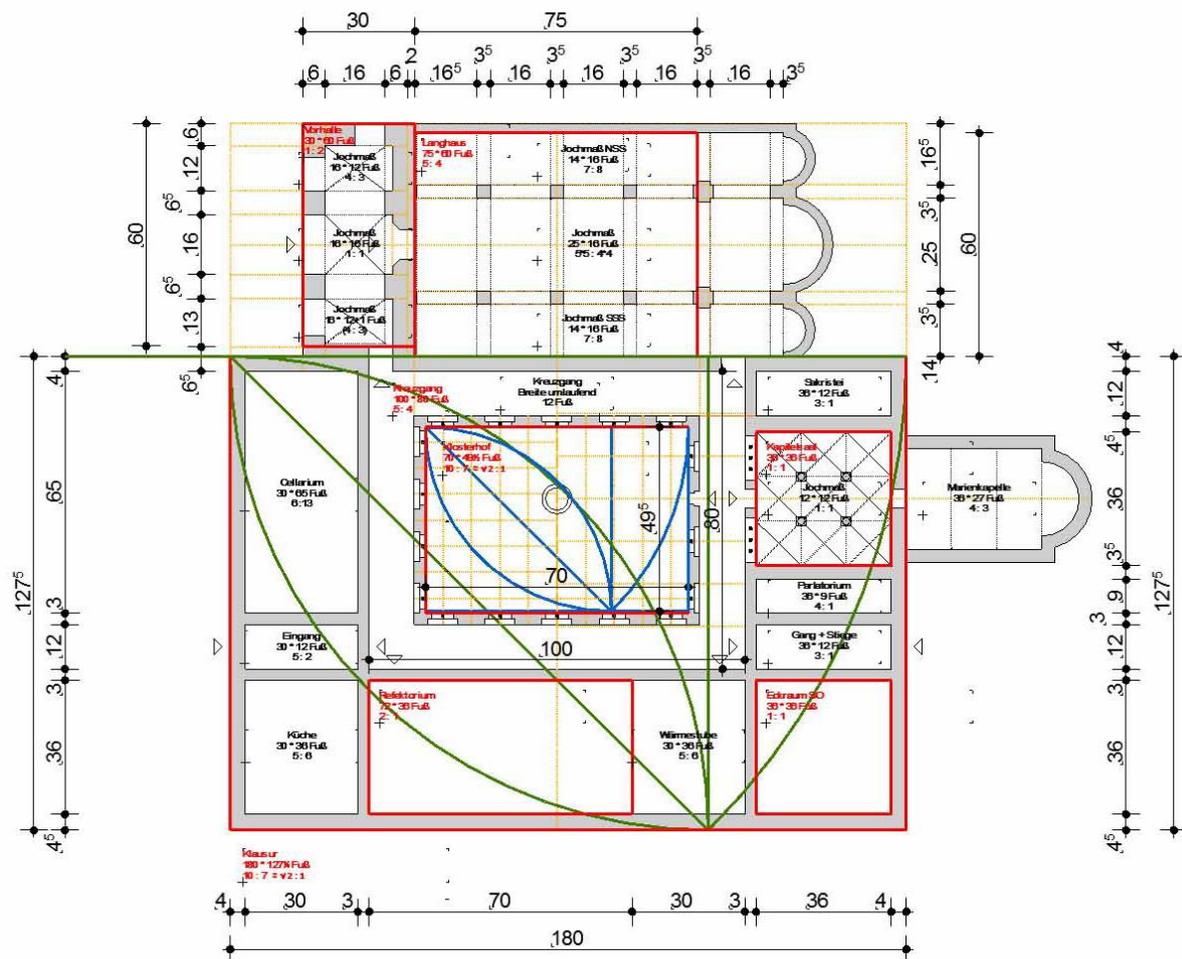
Rekonstruierter Entwurfsplan der Klausur des Benediktinerklosters in Millstatt: Eintragung der Grundrissproportionen sowie des geometrischen Konstruktionsvorgangs des Klausurrechtecks und des Klosterhofs, alle Maßangaben in mittelalterlichen Fuß von 31,1 cm.
